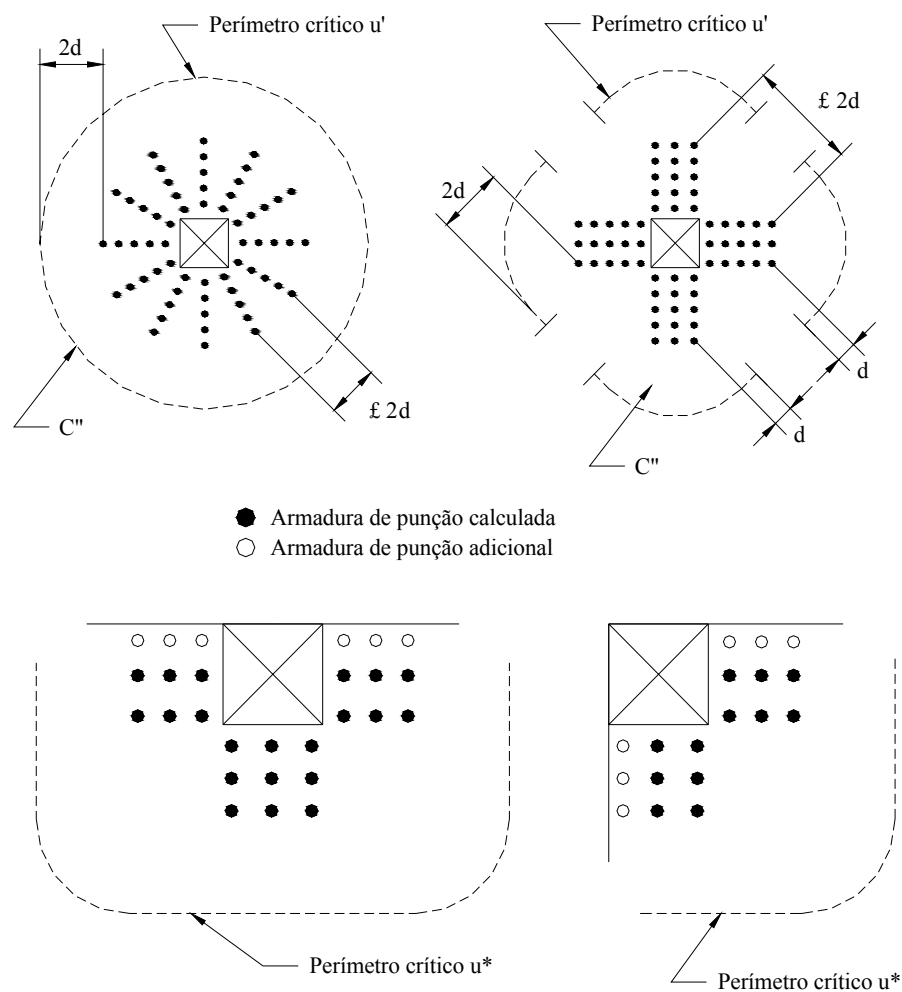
16 Detalhamento da armadura de punção vista em planta
